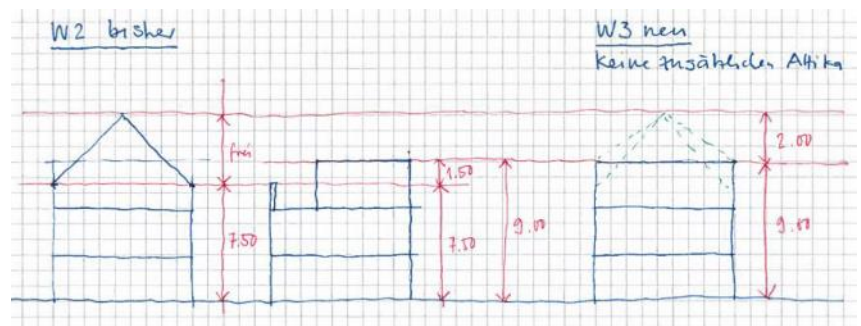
Vergleich verschiedener Bauformen: Die W2 mit Attika oder Dachausbau wirkt volumetrisch wie eine W3 ohne Attika oder Dachausbau
